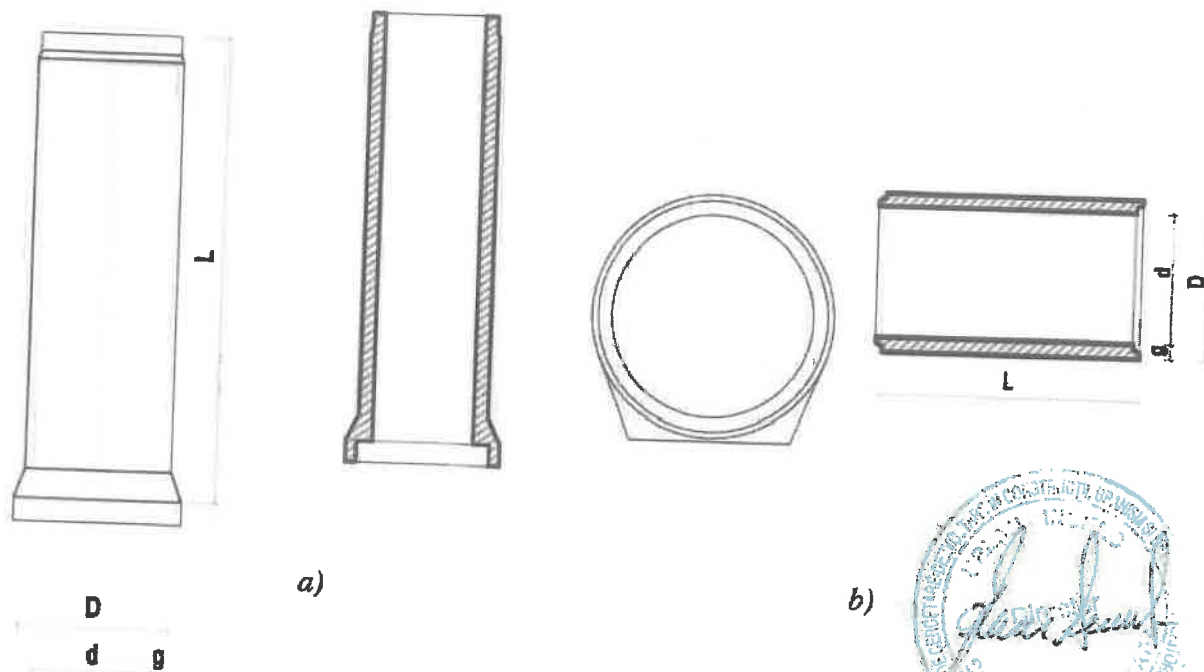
Tuburi din beton armat a)- varianta mufă ;b)- varianta nut-feder (cep și buza)
